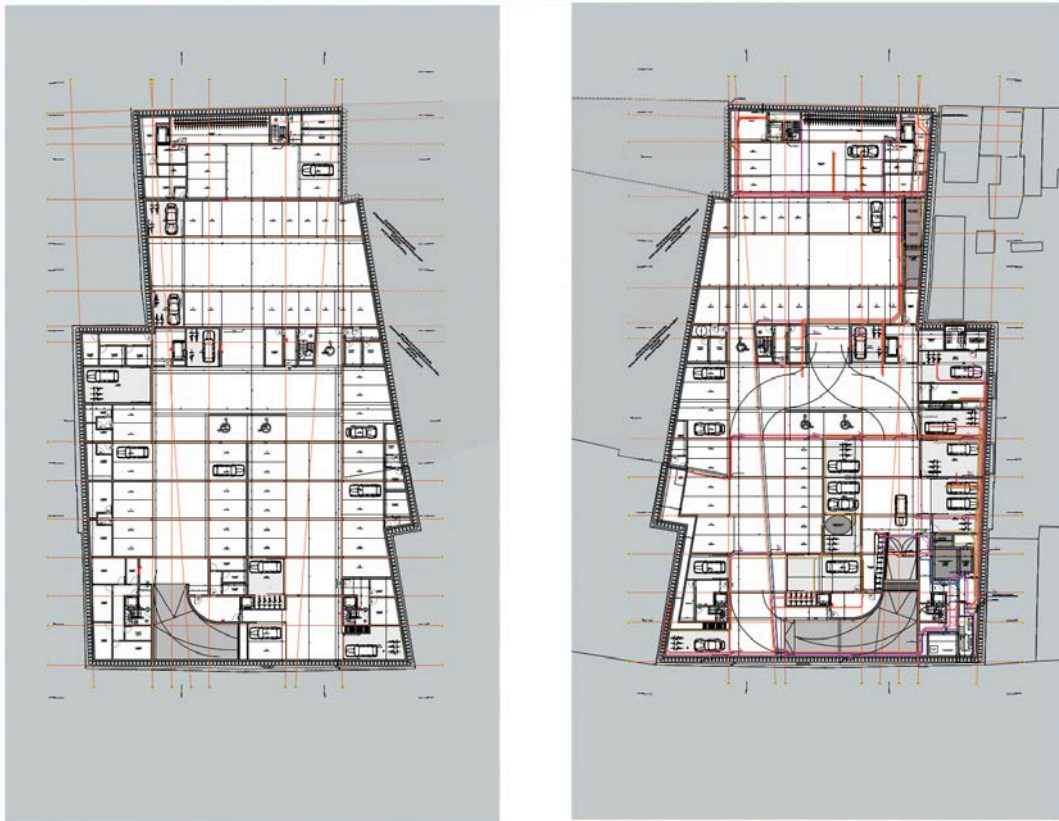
Inplantingsplan van de ondergrondse parkeergarage: niveau -2 (links) en niveau -1 (rechts).
